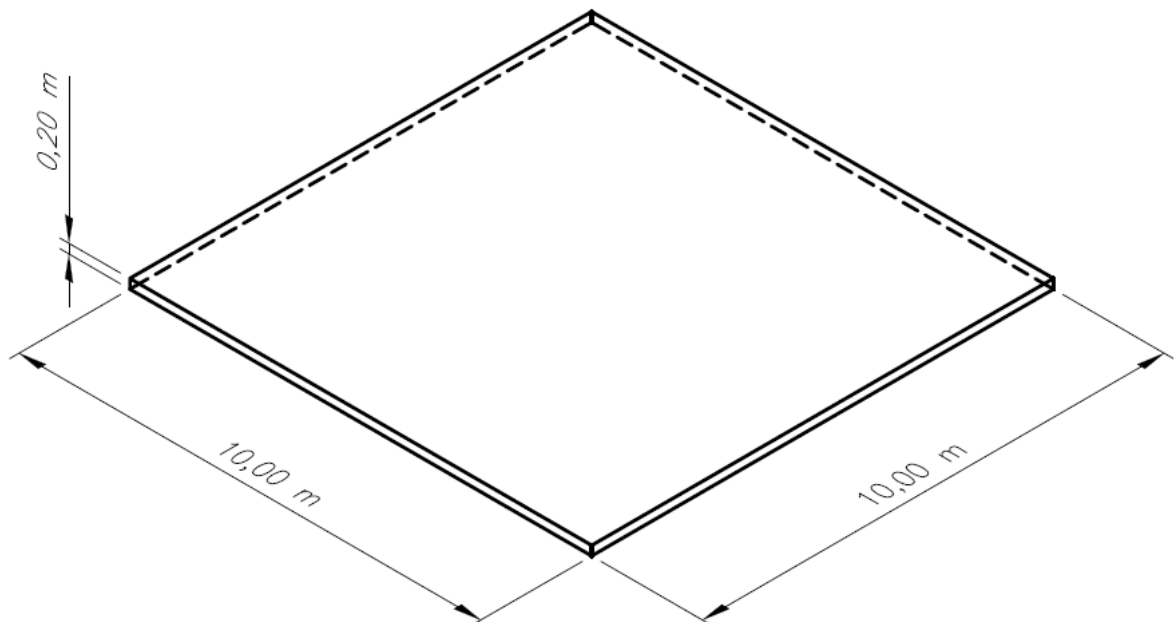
laje 5 - dimensões 10,00 x 10,00 x 0,20 m
